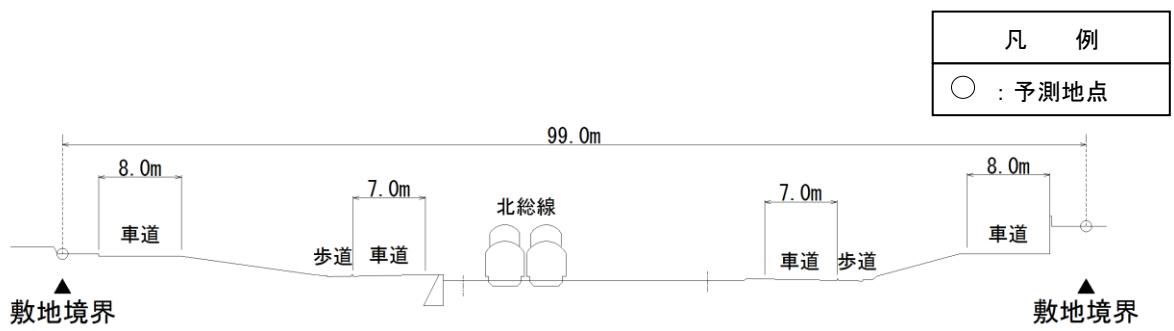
(11) 予測断面图 (K. 一般国道464号 (7))
